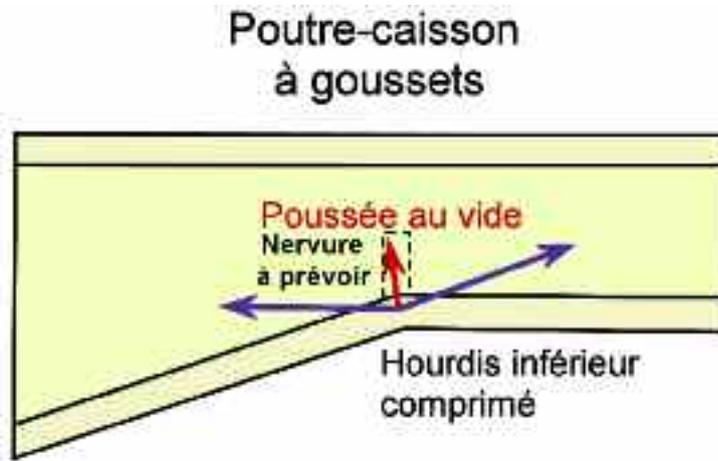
poussée au vide dans une poutre-caisson comportant un gousset
